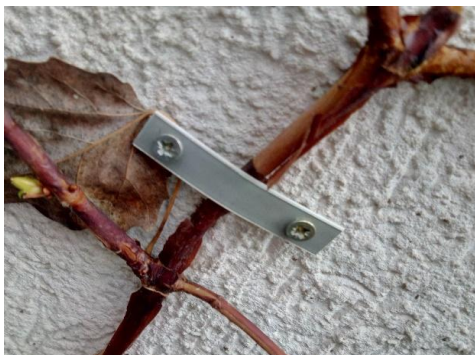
Beispiele für aus bautechnischer Sicht ungeeignete Rankhilfen und Befestigungen (Bildquelle: TU Wien, 2019)
